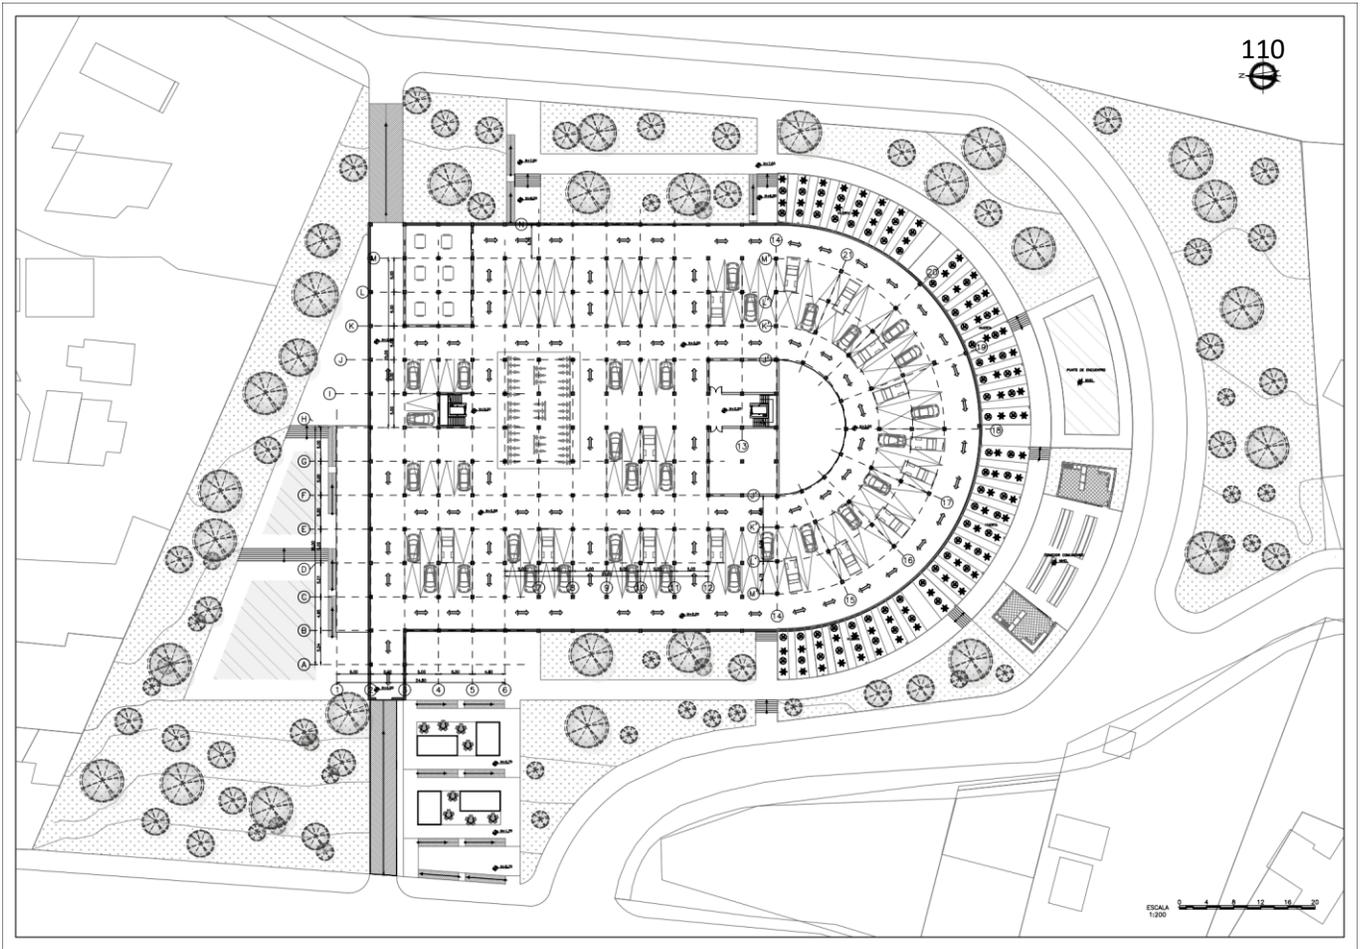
Desarrollo arquitectónico planta cubiertas. Fuente: Elaboración propia.
